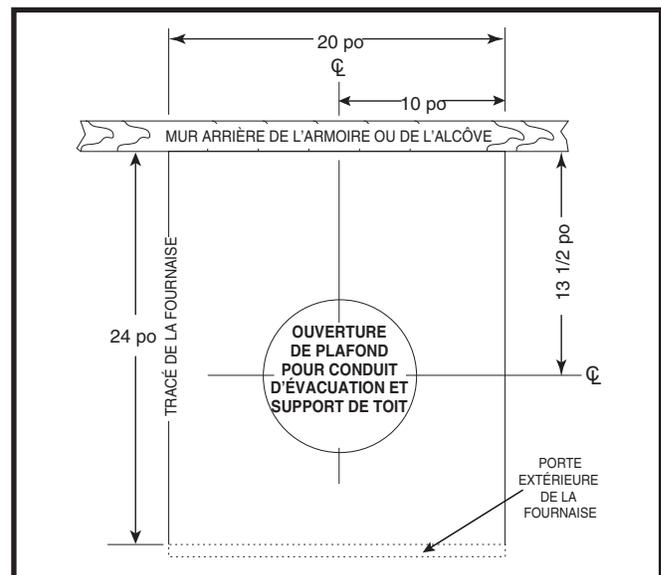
Dimensions de coupe pour le conduit d'évacuation et le support de toit
